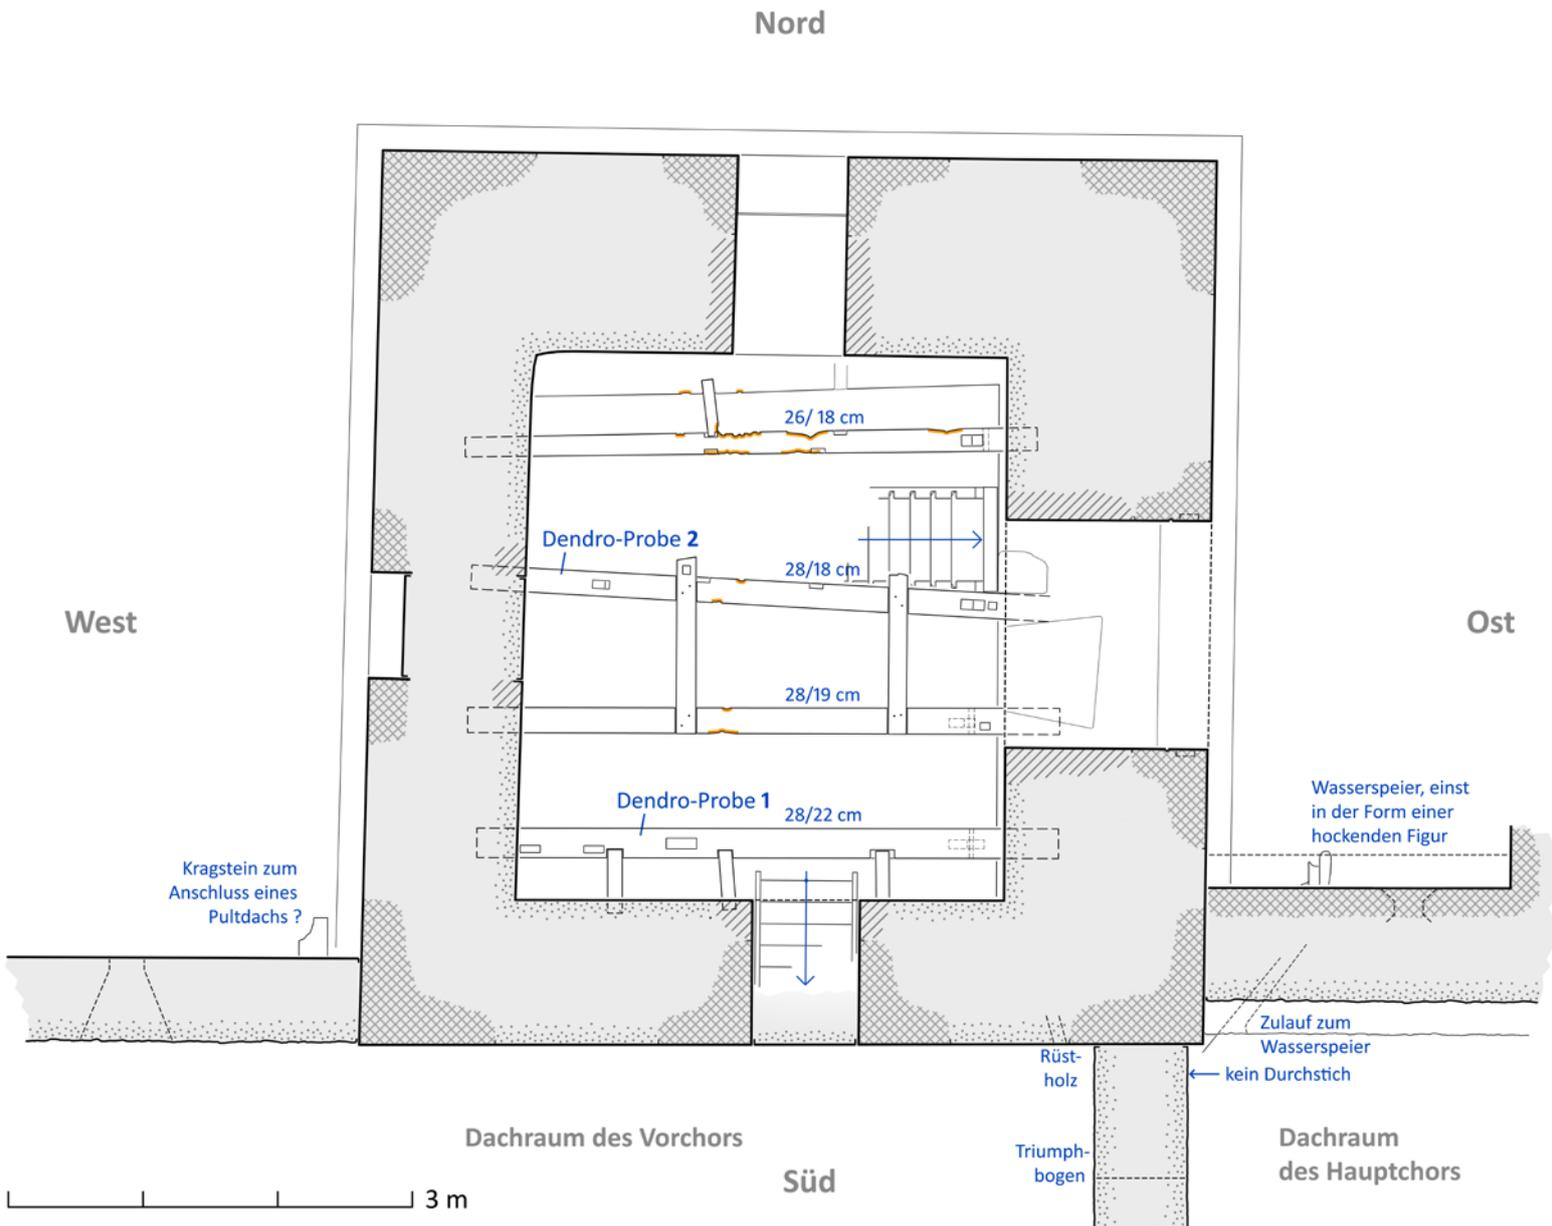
Grundrisszeichnung des dritten Turmgeschosses mit Aufsicht auf die Balkenlage – kreuzschraffiert: Werkstein, schraffiert: Backsteinmauerwerk, gepunktet: offenes Bruchsteinmauerwerk, breit gestrichelt: oberhalb der Schnittebene befindliche Wölbungskanten, schmal gestrichelt: Zapfenlöcher an Balkenunterseite und horizontale Dübel, oranger Rand: Reibspuren von Glockenseilen und Seilzügen für den Stundenschlag.
